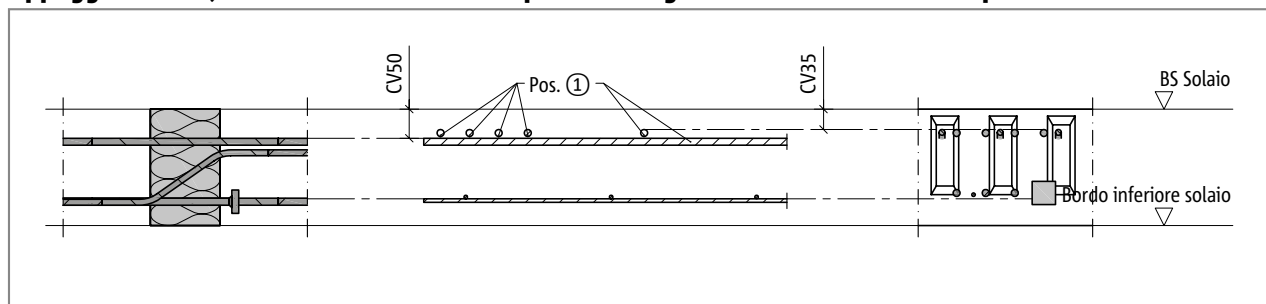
Schöck Isokorb® tipo EXT: armatura in opera angolo esterno (sezione EXT-L-CV50; vista EXT-R-CV35)
